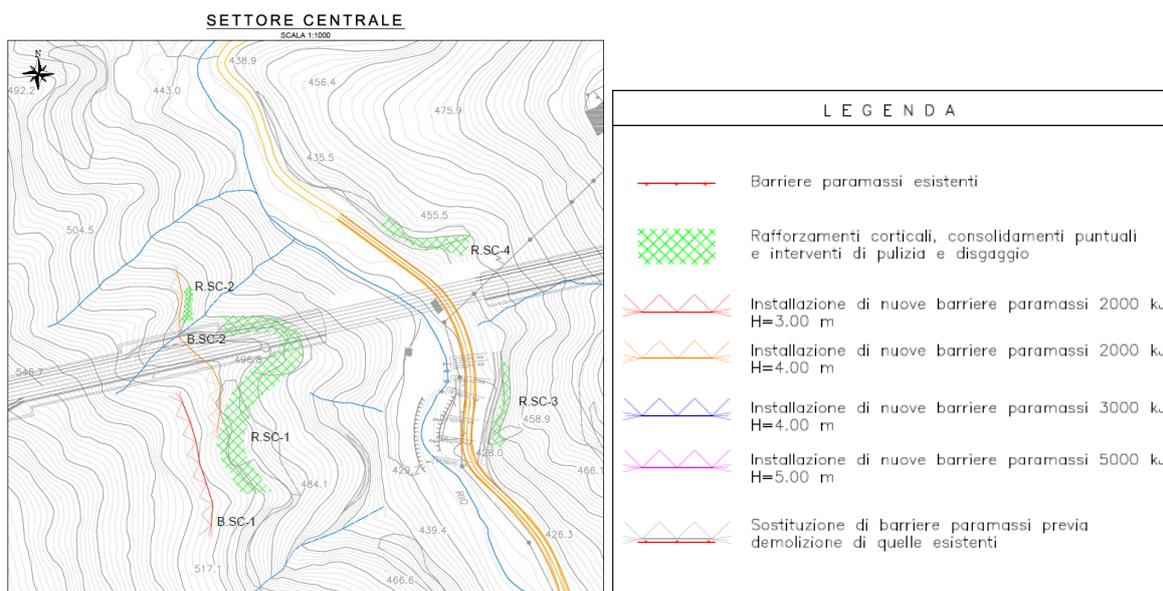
Stralcio planimetrico delle opere di protezione da caduta massi del settore centrale
